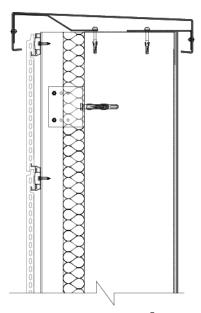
Kit Tempio[®] FK. Sección vertical. Coronación de fachada.
